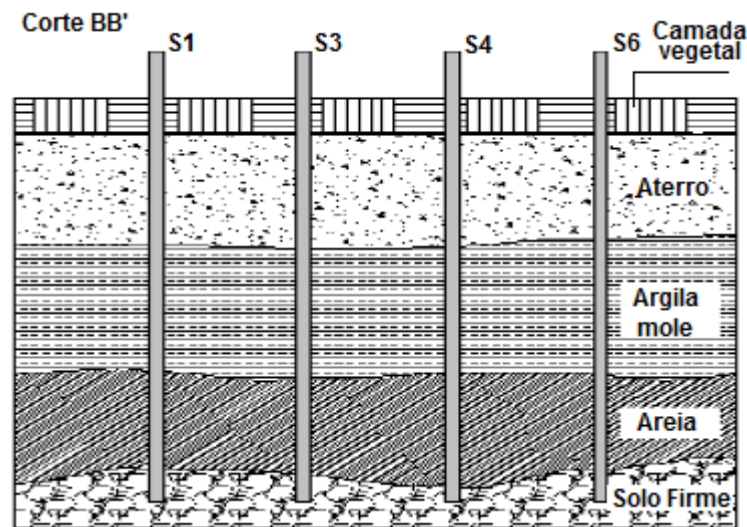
Corte BB' do subsolo da obra [adaptado de 20]
